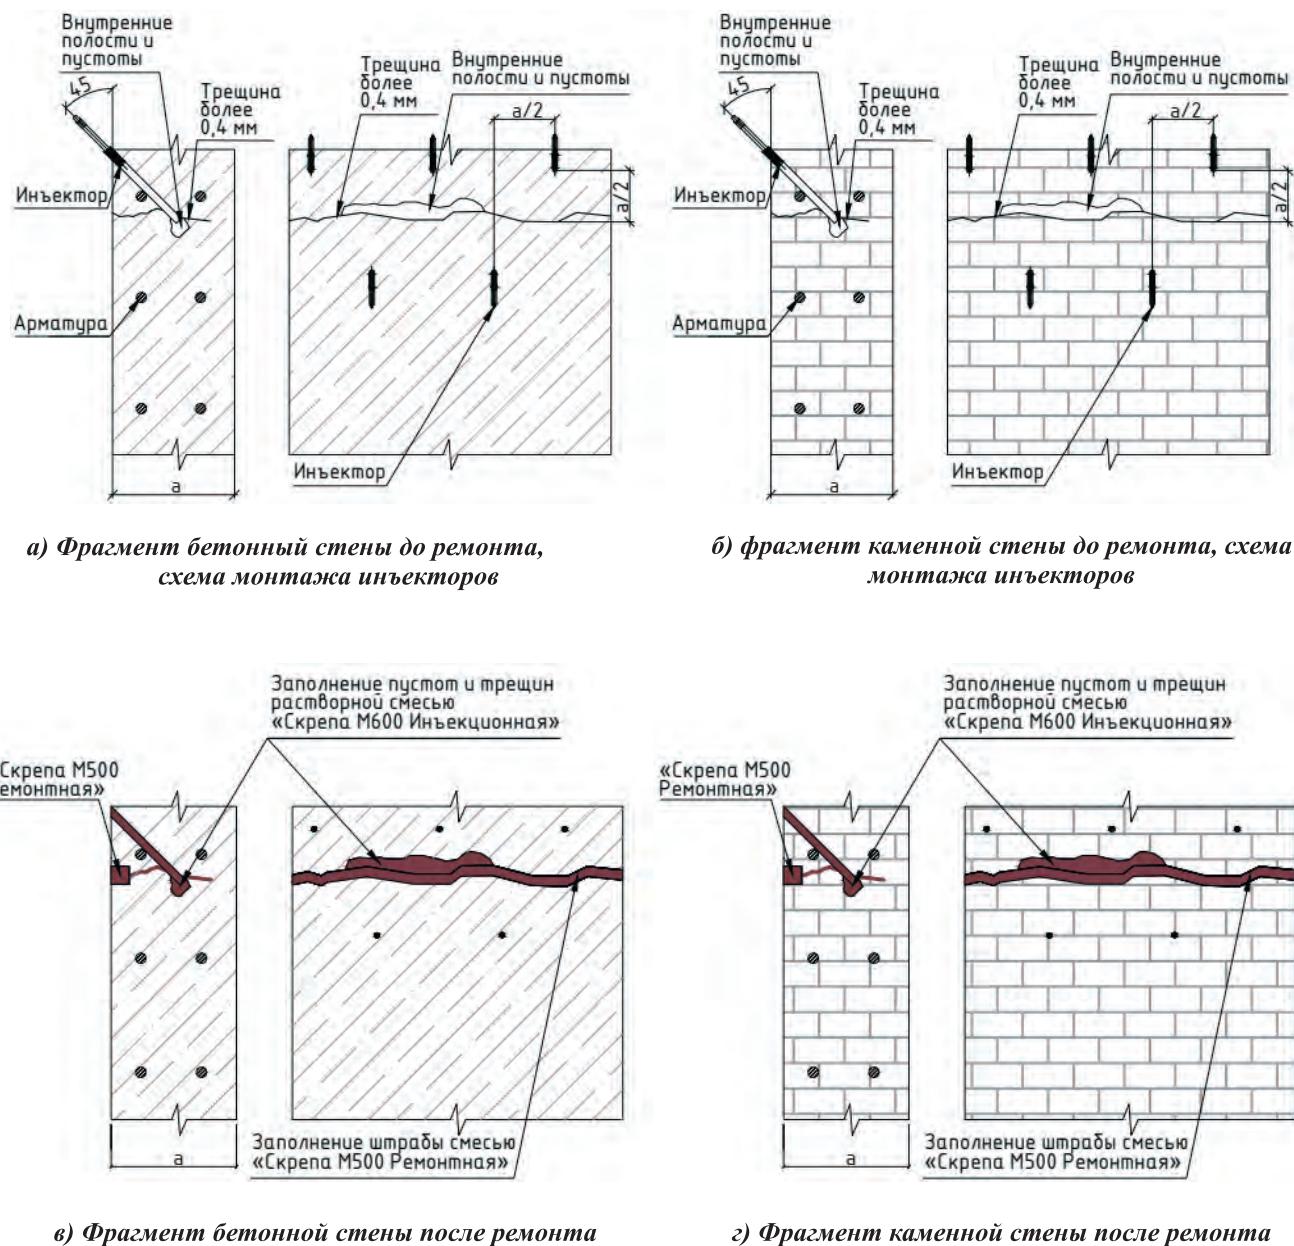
Схема заполнения трещин и пустот в монолитной бетонной или каменной стене
